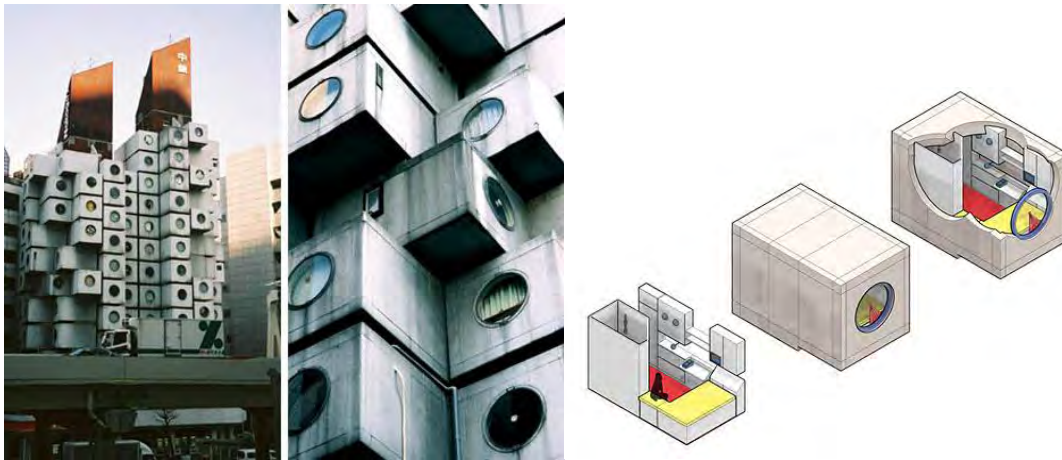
Nagakin Capsule tower 1972, Tokio Japón, www.fiorebuildingworkshop.com
